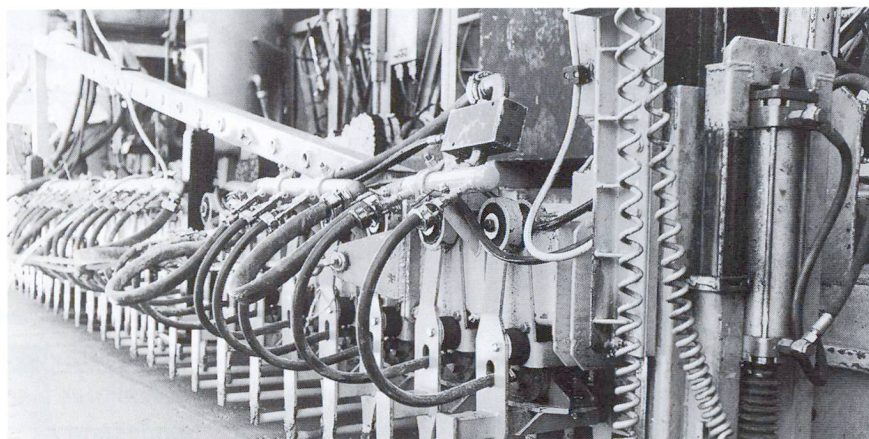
Les goujons sont placés ou introduits par vibration dans les joints transversaux, mécaniquement.
